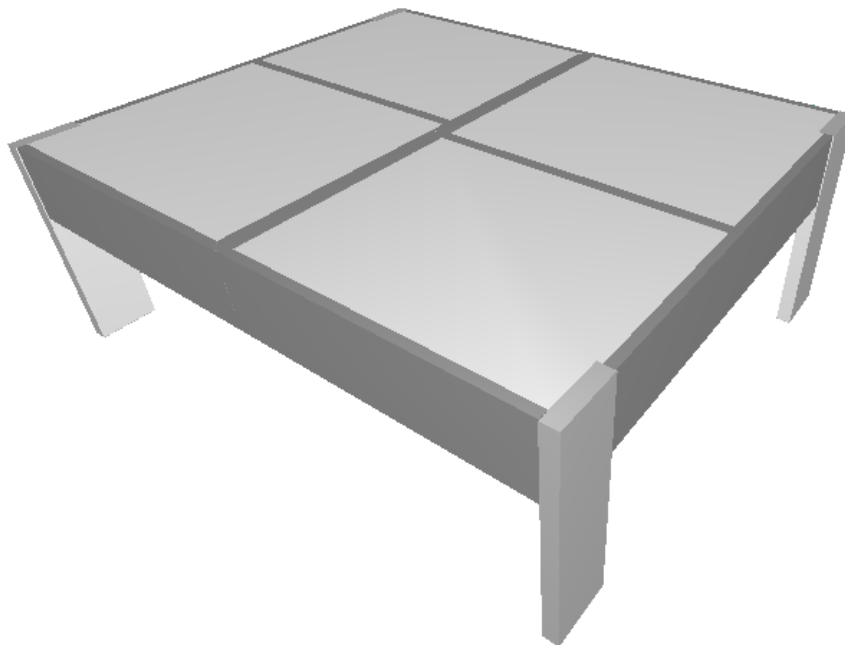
Vista tridimensional do modelo do piso com adaptação plástica
